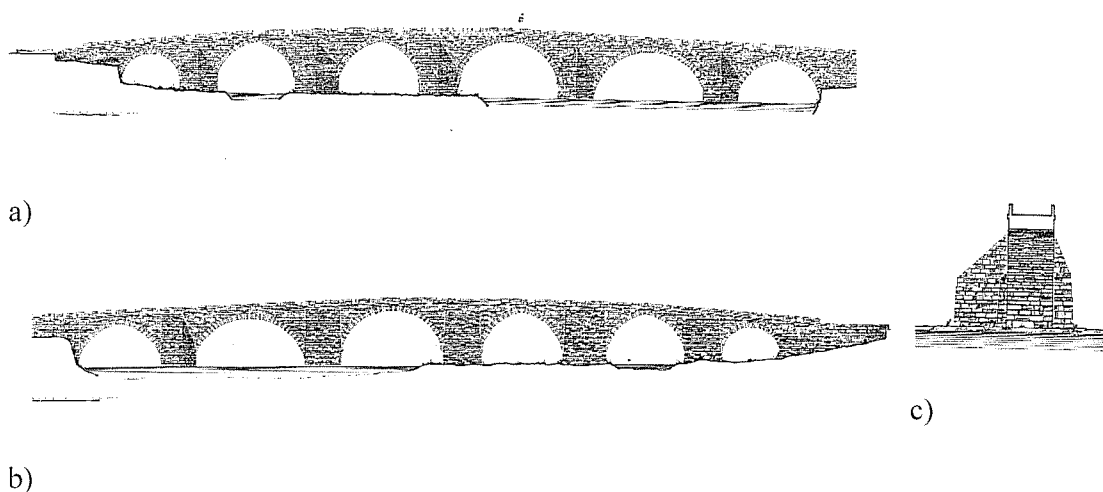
Alçado de montante (a) e jusante (b) e corte transversal (c) da ponte da Lagoncinha
